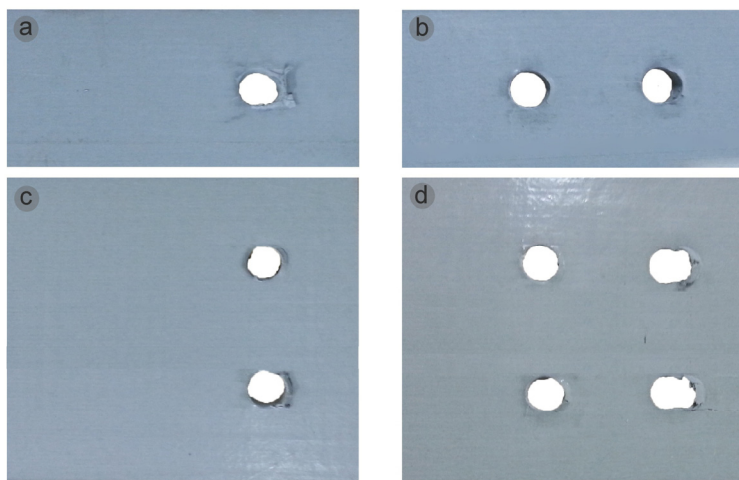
Cedarea prin strivire a îmbinărilor cu șuruburi / Bearing failure of the bolted joints
